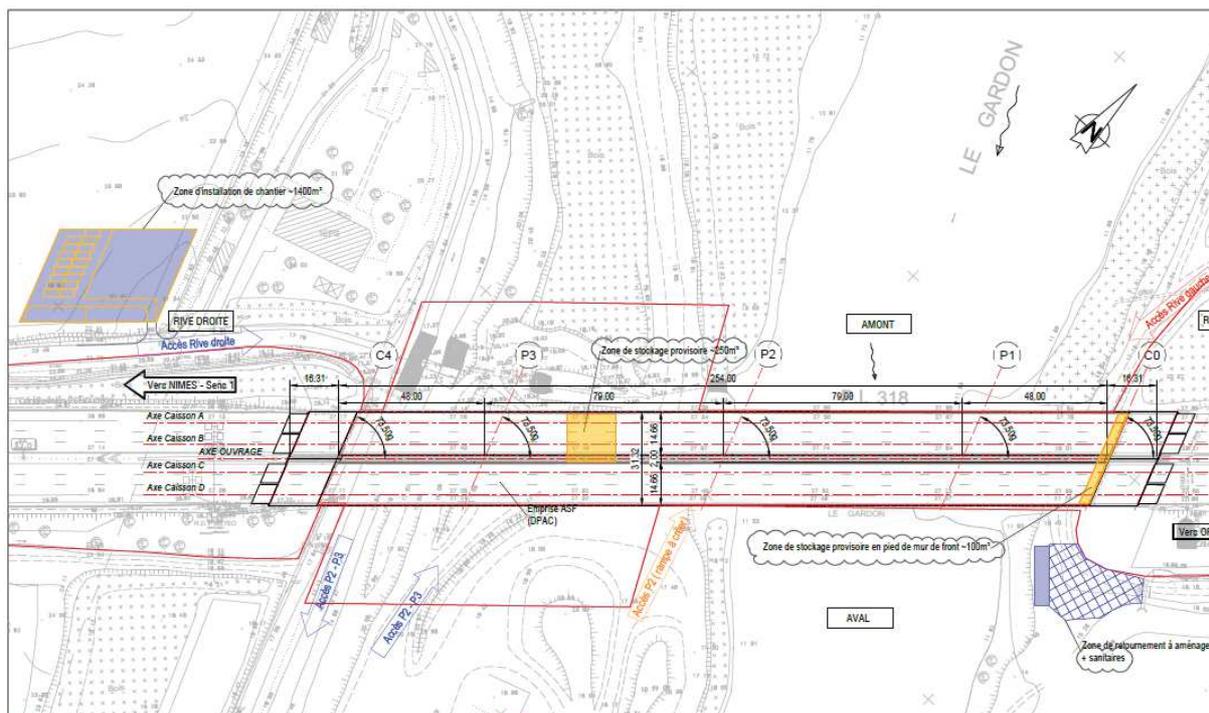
Vue en plan général des accès et installations (Arcadis, 2021)
